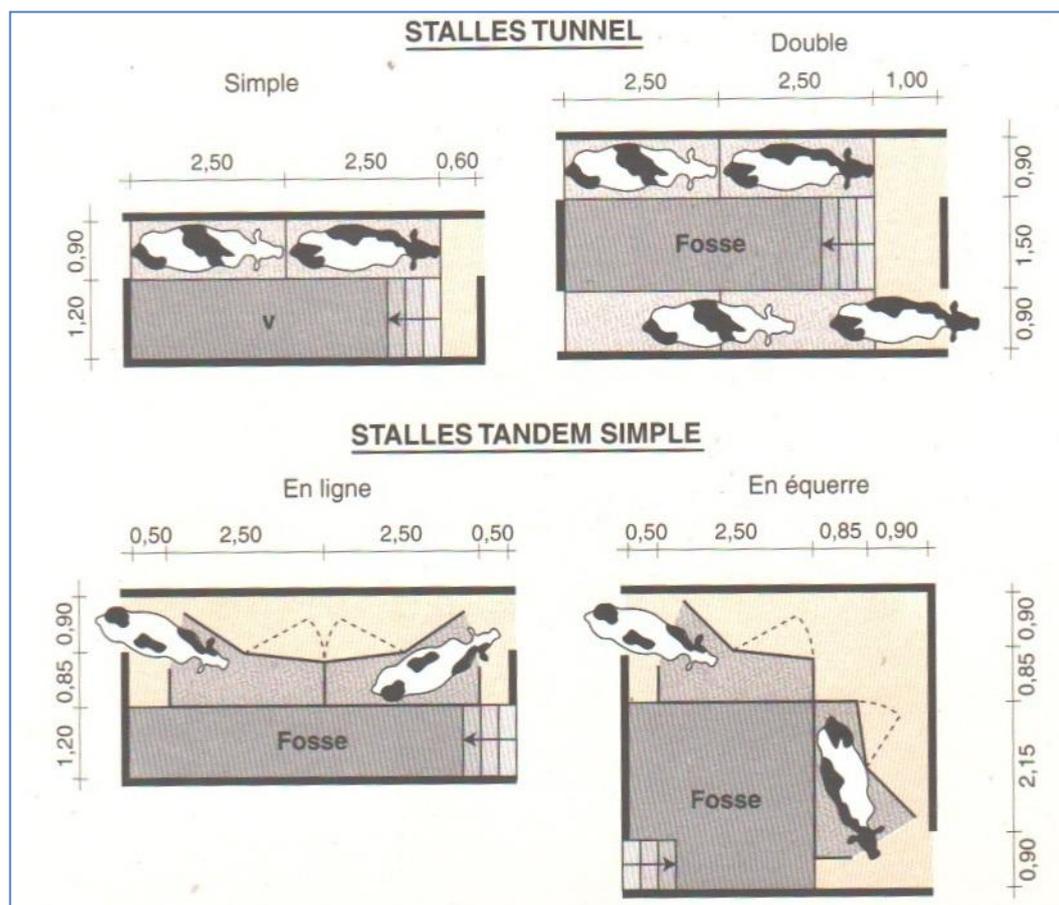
Salle de traite en tunnel ou en tandem [7]
